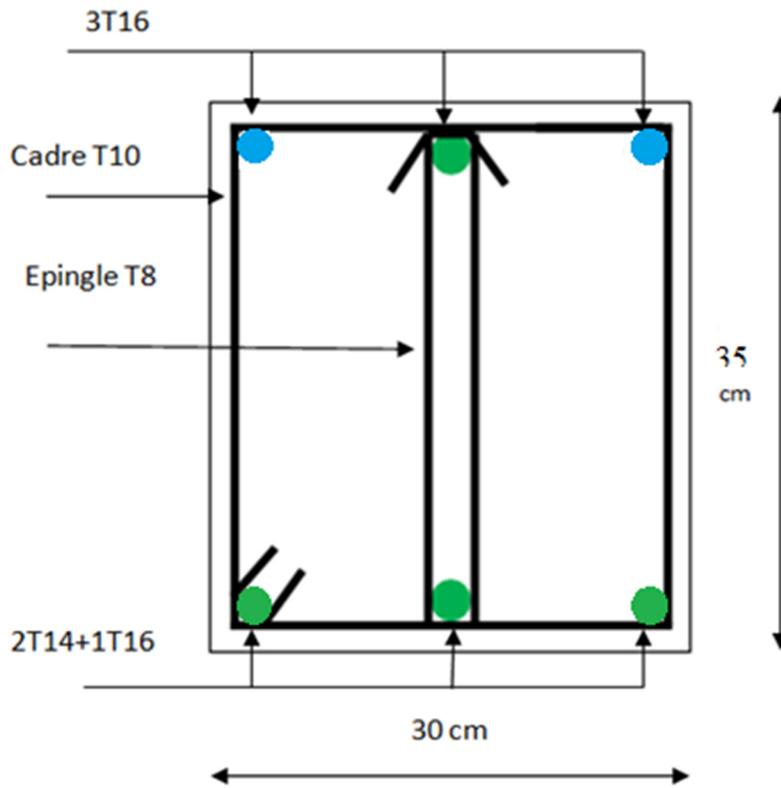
Schéma de ferrailage d'une poutre secondaire en travée
